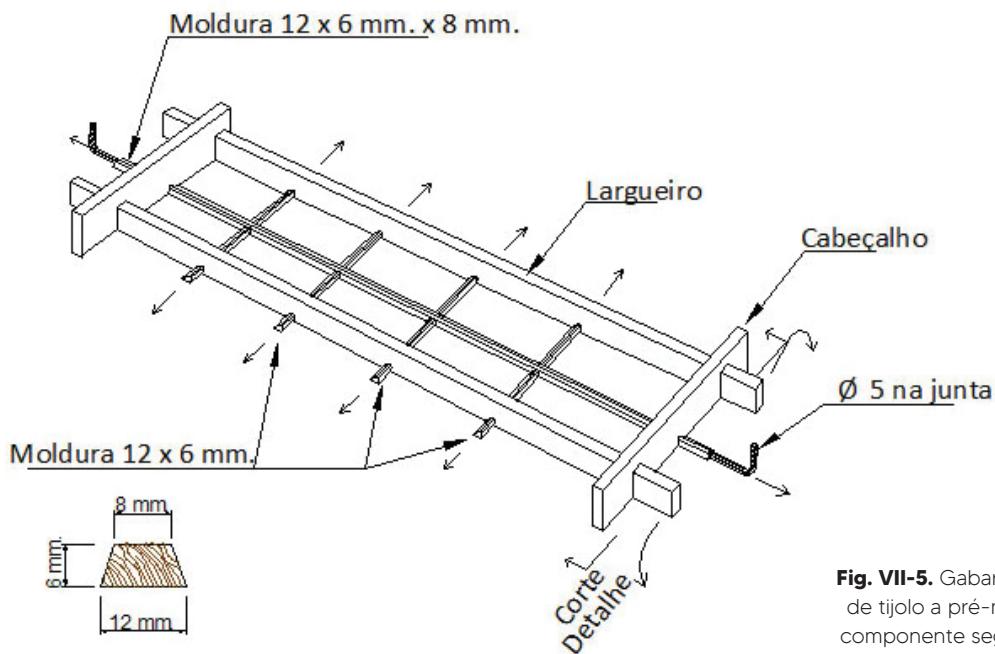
Gabarito para fazer de tijolo a pré-moldagem do componente segundo Cap. II, Fig. II-36 e seguintes. (*-5).
